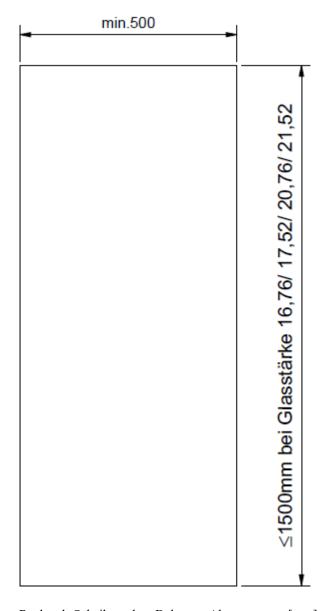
Abmessungen Rechteck-Scheiben ohne Bohrung, Abmessungen [mm]
